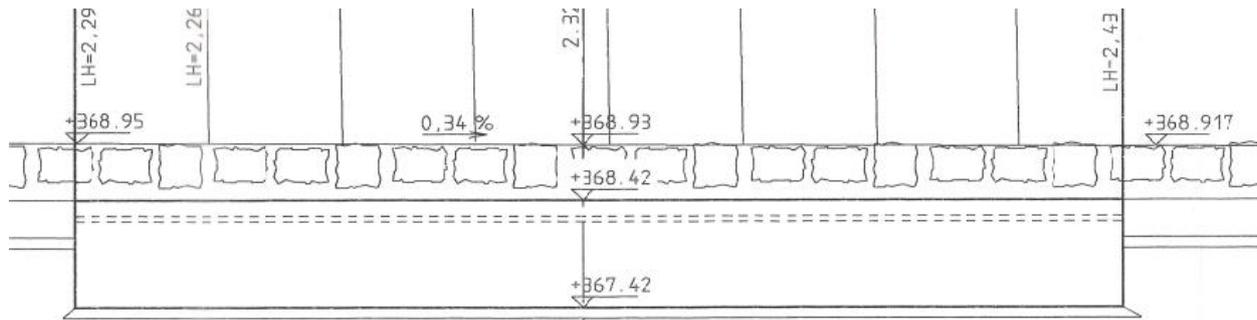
Sohlauflaufhöhe gemäß Bestandsplan Brücke Hauptstraße (LRA Altötting)
